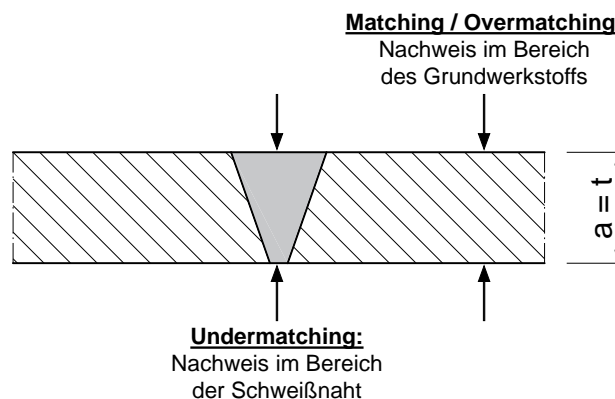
Bemessung einer durchgeschweißten Stumpfnah nach *prEN 1993-1-8* [18]
